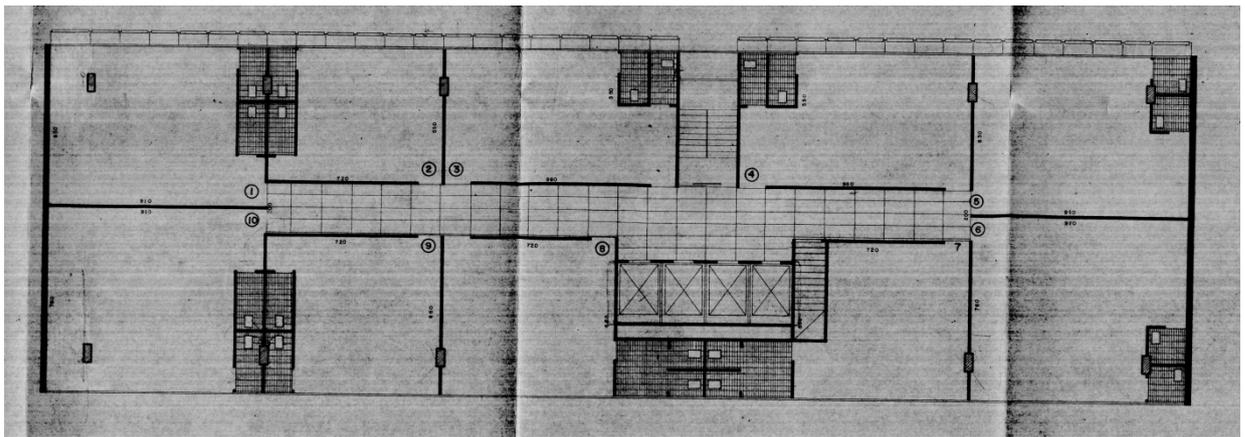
Planta do pavimento tipo, projeto original com as divisões por conjuntos de escritórios.
